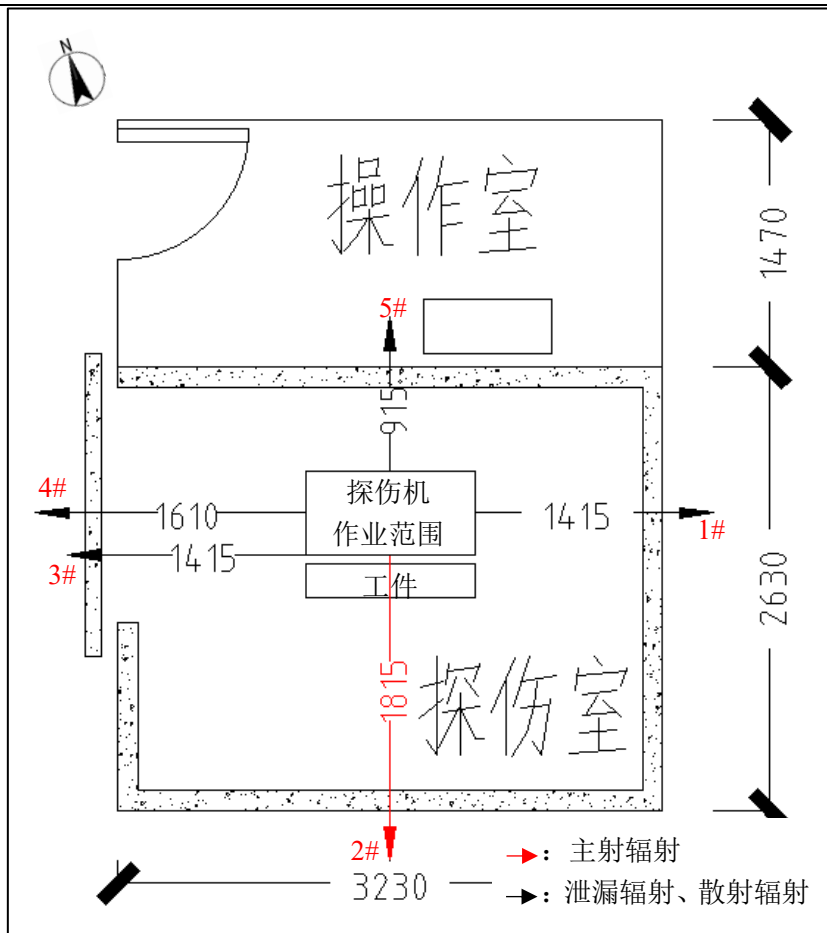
本项目探伤室预测点位平面示意图（单位：mm）
